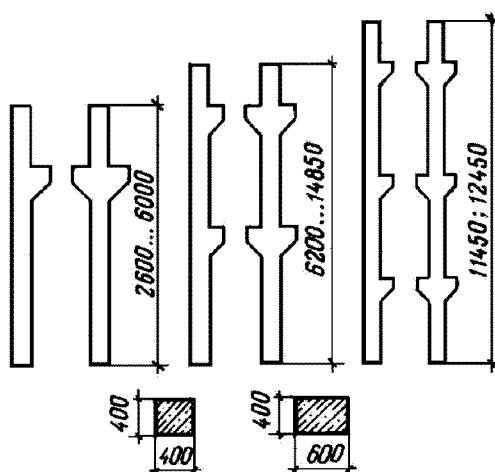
Типи залізобетонних колон багатоповерхових промислових будівель.
